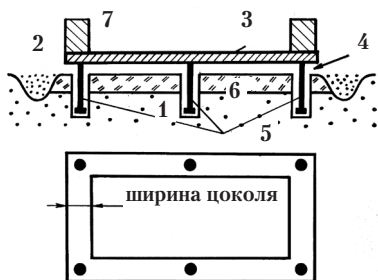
Монтаж фундамента на глубоководных столбах (внизу – вид сверху). 1 – материковый грунт, 2 – дренажные каналы (могут быть засыпаны крупным песком), 3 – бетонный или металлический ростверк (рандбалка), с жёстким креплением на столбах, 4 – зазор 15–20 см между летним уровнем грунта и ростверком, 5 – бетонные или металлические столбы с нижними расширителями (подпятниками), 6 – слой утепляющего материала, 7 – цоколь, устанавливаемый на ростверк.
